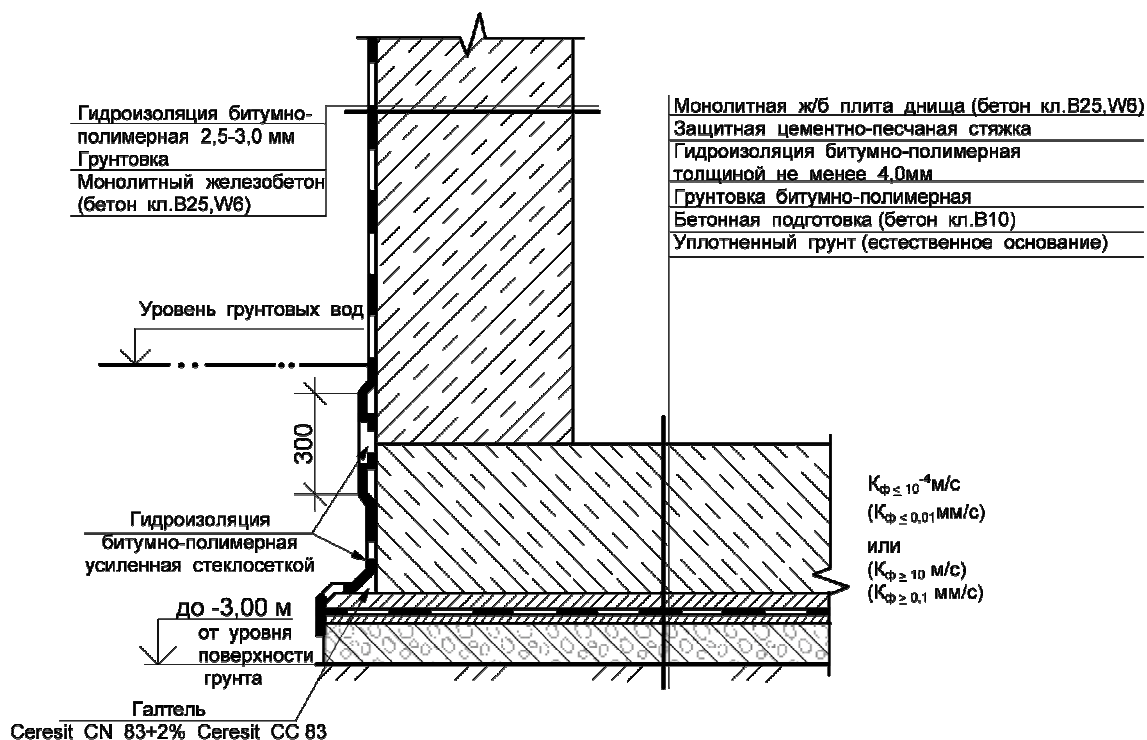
Наружная битумно-полимерная гидроизоляция бетонных плит основания и стен подземных сооружений в условиях воздействия грунтовой воды под давлением
